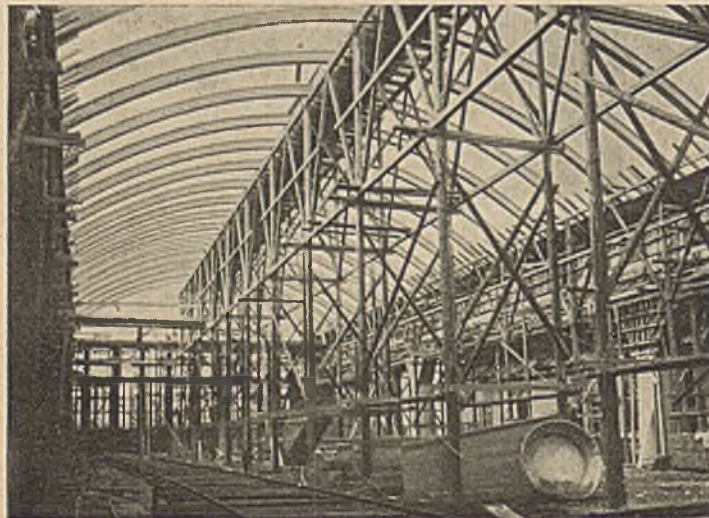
Halleninneres mit den fertig verlegten Dachbindern und Gerüst.
